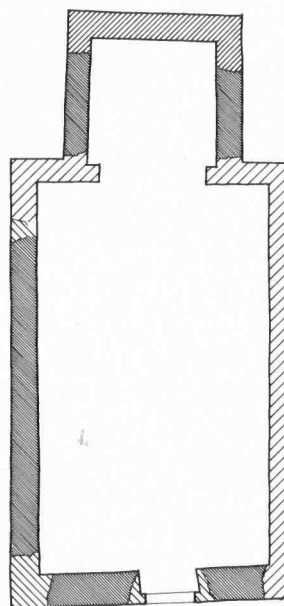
Grundriss 1:200 mit den verschiedenen Bauphasen im aufgehenden Mauerwerk. (Situation etwa 50 cm über aktuellem Kirchenboden, Norden links.)
